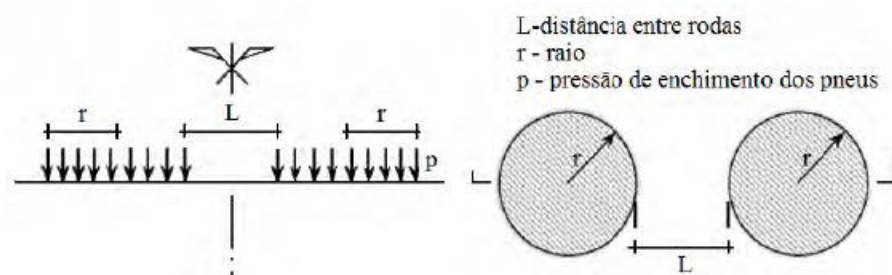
Esquema adaptado para a acção de um eixo-padrão sobre um pavimento (Branco et al. 2008)
